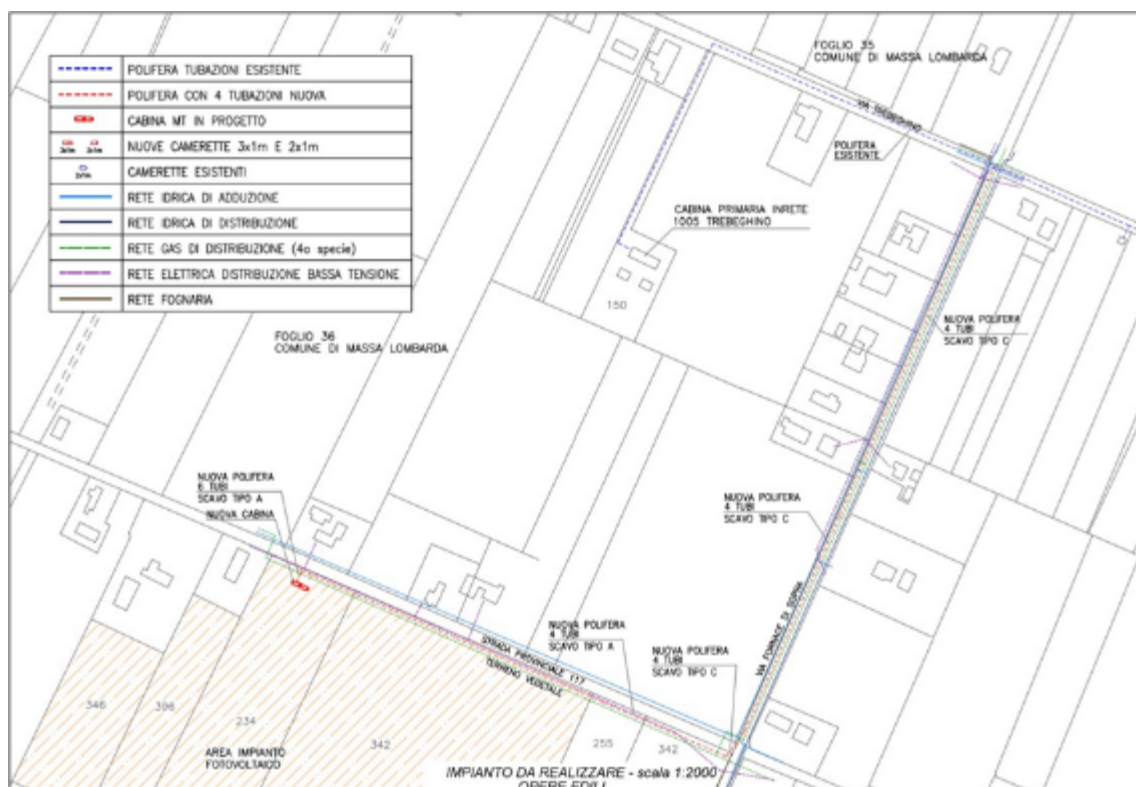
Estratto planimetria di progetto dell'impianto di connessione
